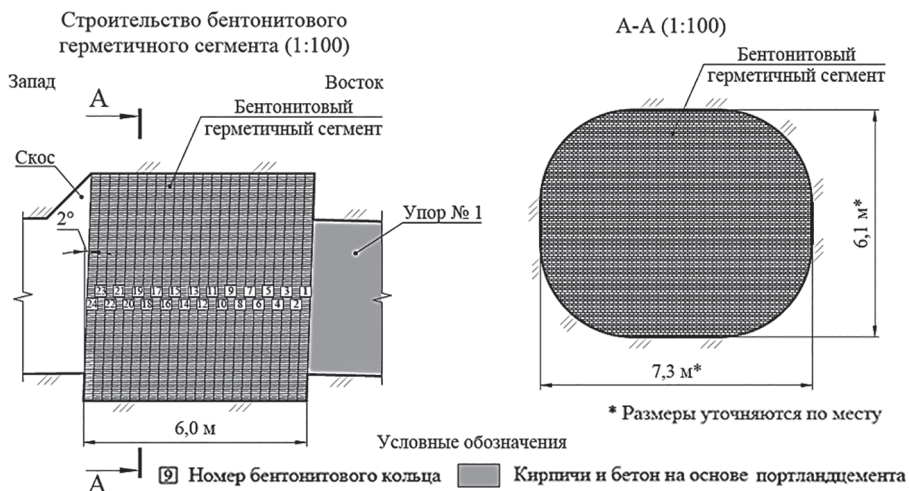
Типовая схема строительства бетонитового герметичного сегмента
